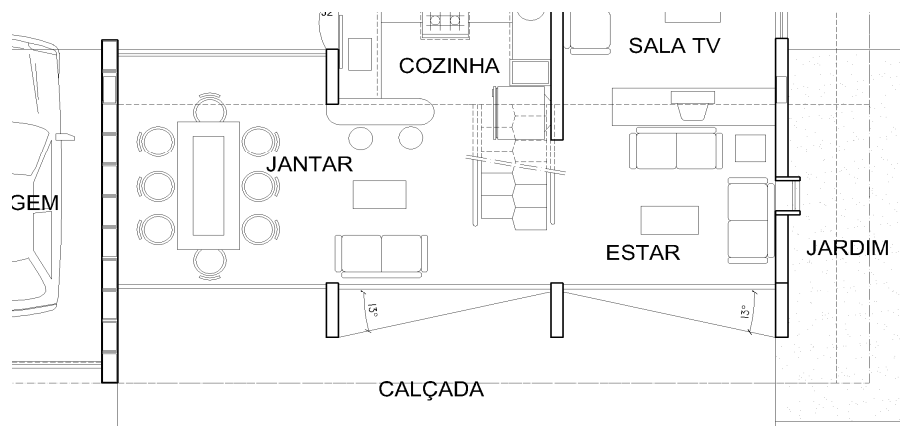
Projeto 2 - Planta – ângulo de proteção do elemento vertical na Fachada Sul
